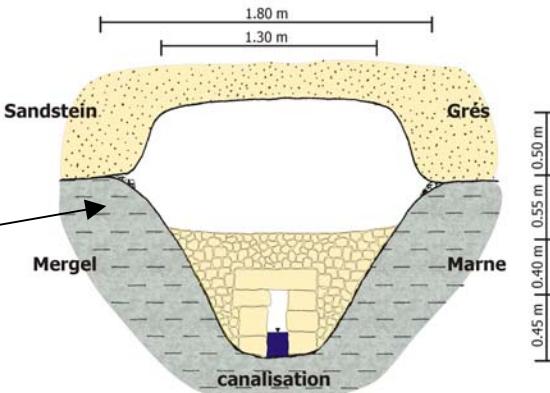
Coupe transversale du tunnel et de la conduite d'eau près du puits 5 (voir aussi fig. 6)
